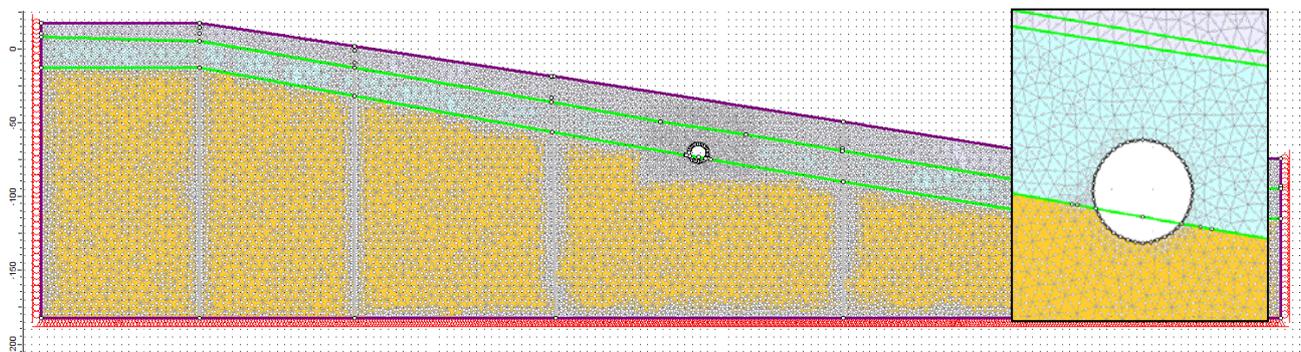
Analisi bidimensionale con scavo in meccanizzato – Sezione di calcolo
